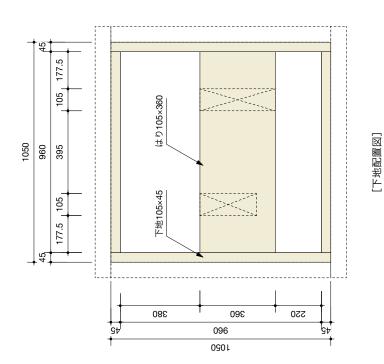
試験体 2-2 壁-床取合い部 割付図
